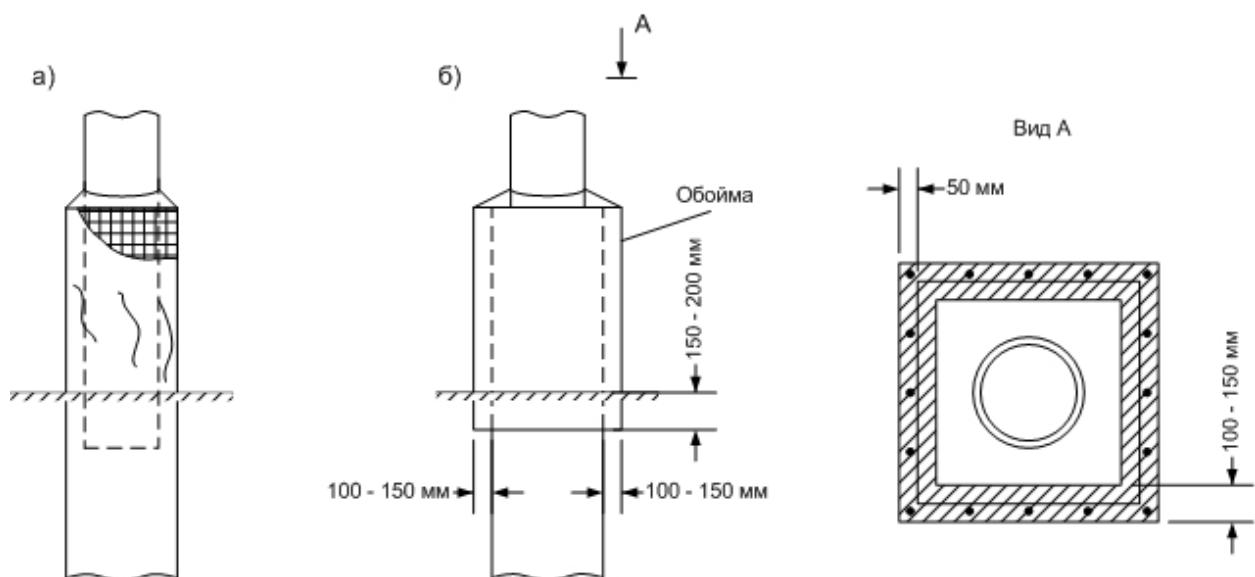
Ремонт стаканного фундамента путем установки железобетонной обоймы:
